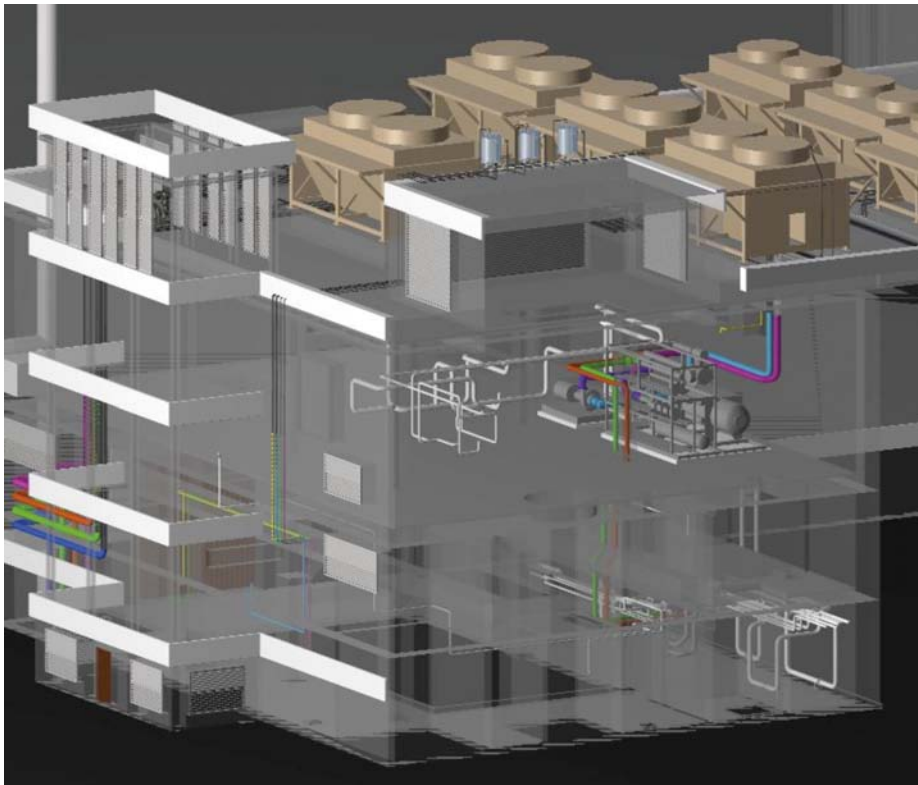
Vista esquemática general de la modificación del sistema GJ.
